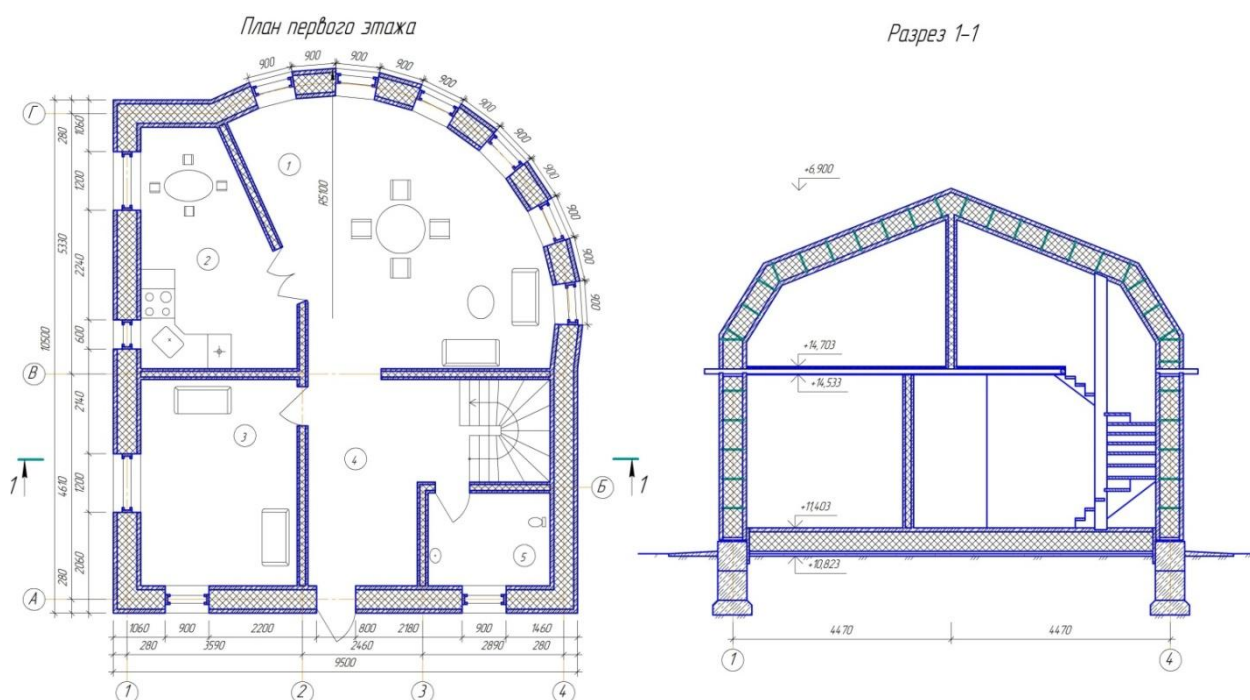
План первого этажа и разрез мансардного жилого дома
